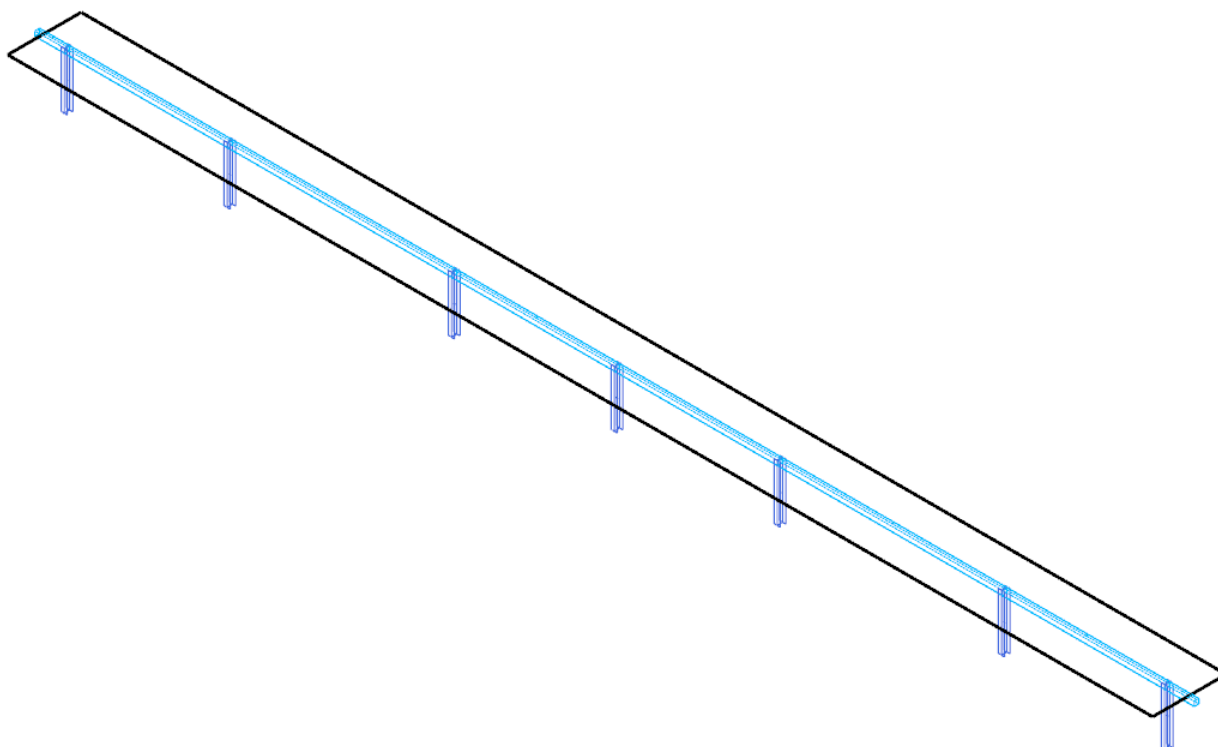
Vista assonometrica modello strutturale con posizione della “vela” orizzontale
